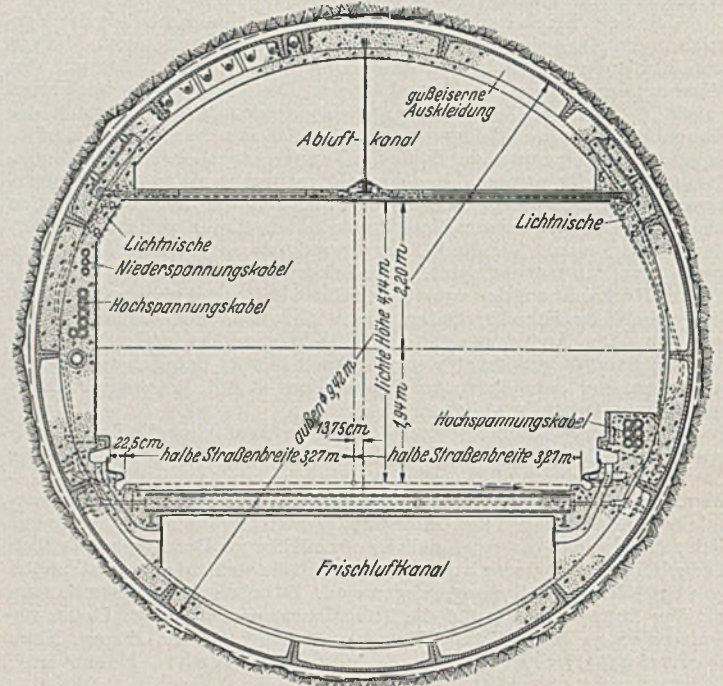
Tunnelquerschnitt der Schildstrecke.
